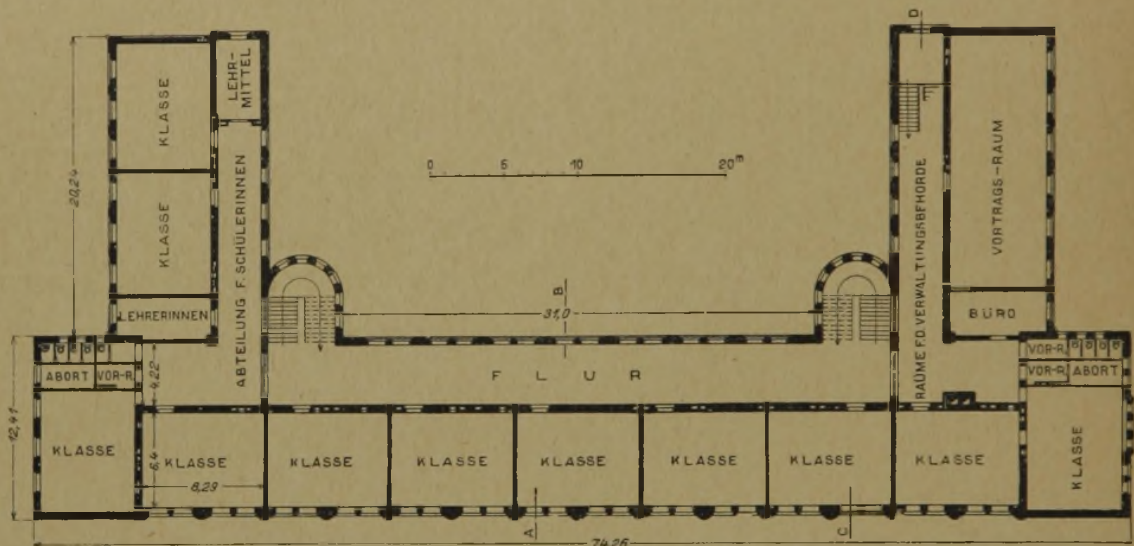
Grundriß des 2. Obergeschosses. (1:500)
